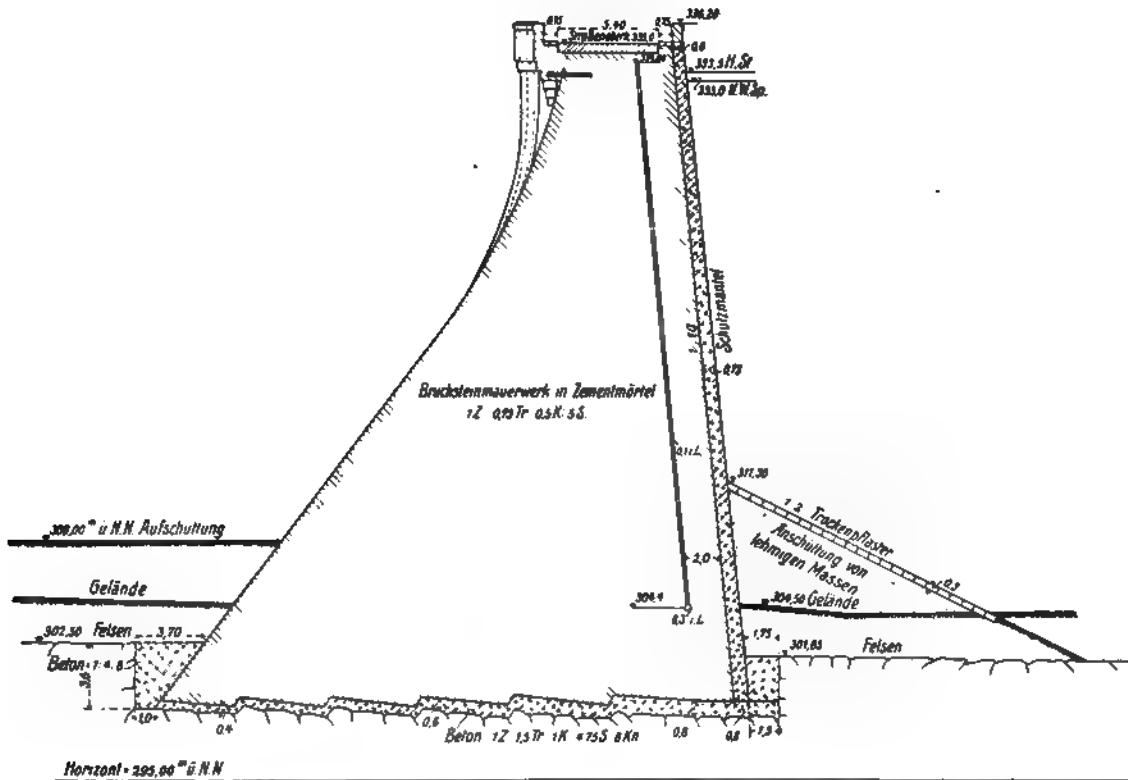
Querschnitt der Mauer bei Bogenpunkt 12.
